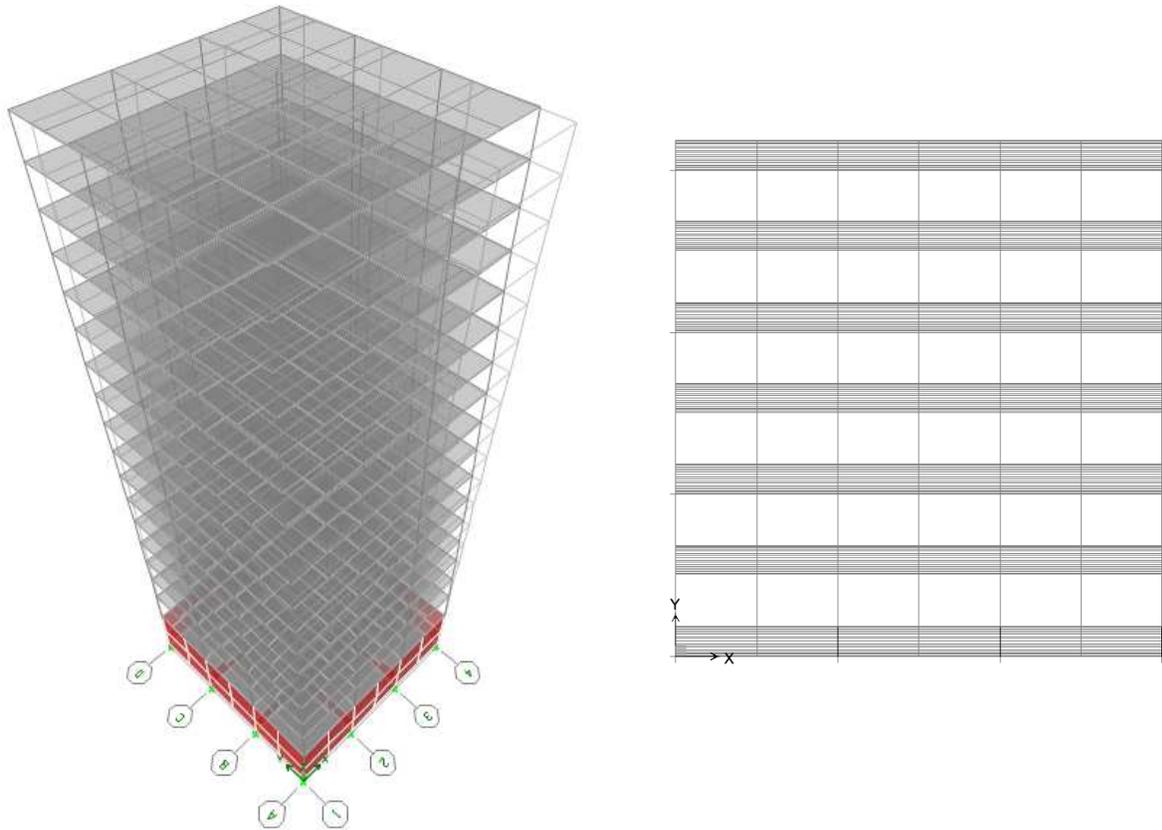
Vista en elevación y planta de de la deformada del segundo modo de vibrar del edificio 17 niveles
